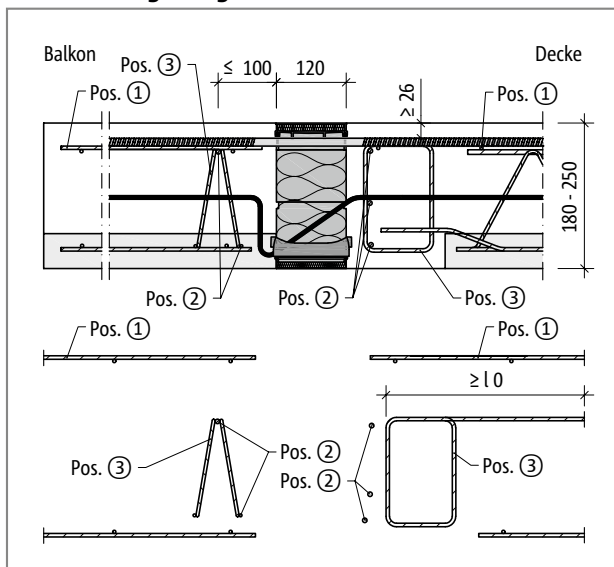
Schöck Isokorb® CXT Typ K-F: Bauseitige Bewehrung bei Balkonplattendicke $h = 180 - 250$ mm mit Gitterträger
